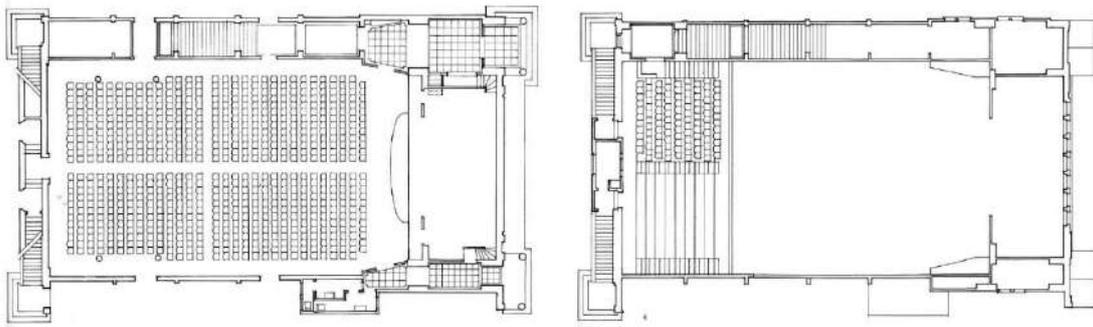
Planta Baixa Primeiro Pavimento do La Scala.
